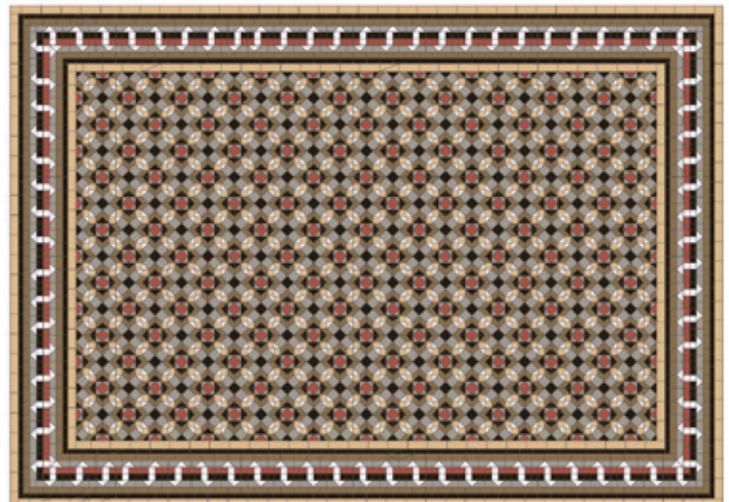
Villa Morris. Pavimento de cerámica Nolla de un dormitorio en la primera planta. Fuente: Autores.
